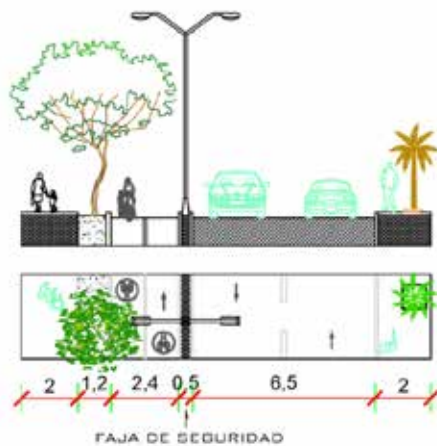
Perfil vial calles internas. Fuente: Propia AutoCad (2019)
